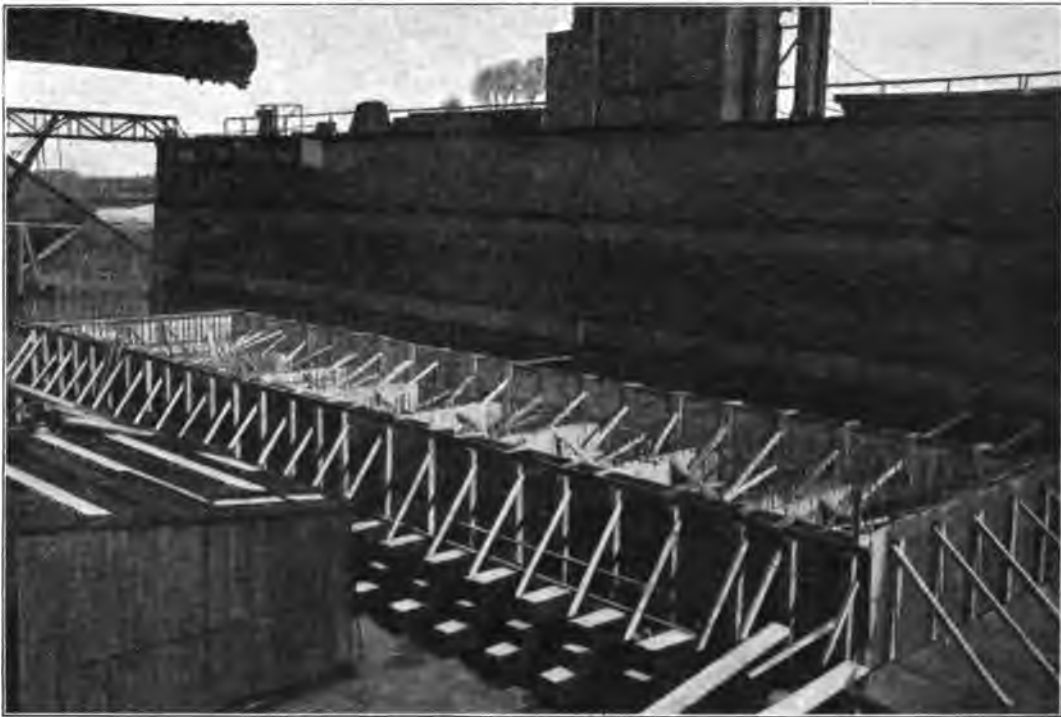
Umbau der Kaimauer am Eisenbahnhof in Rotterdam: Herstellung eines Eisenbetonkastens im Schwimmdock.
